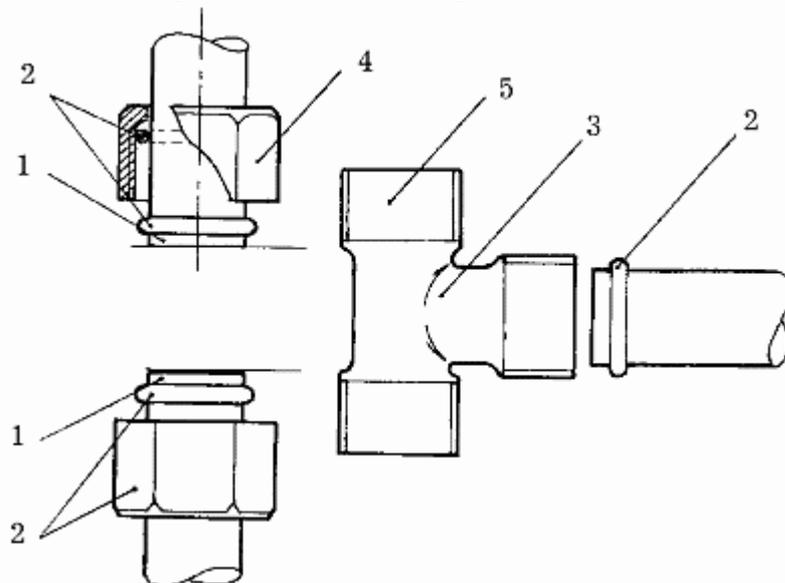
Разрез трубы и подготовка к соединению: 1 – место среза трубопровода; 2 – компрессионные кольца; 3 – тройник; 4 – гайки для тройника; 5 – резьба для гаек.
